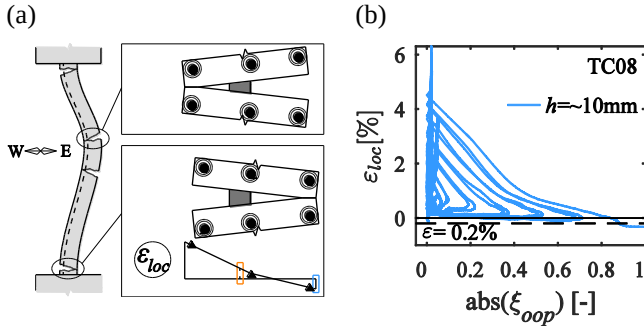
(a) Schema illustrativo dell'instabilità fuori piano, con particolare enfasi sulla chiusura delle fessure e sul profilo di deformazione lungo lo spessore; (b) Evoluzione della deformazione locale dal lato della fessura che si chiude per primo.
